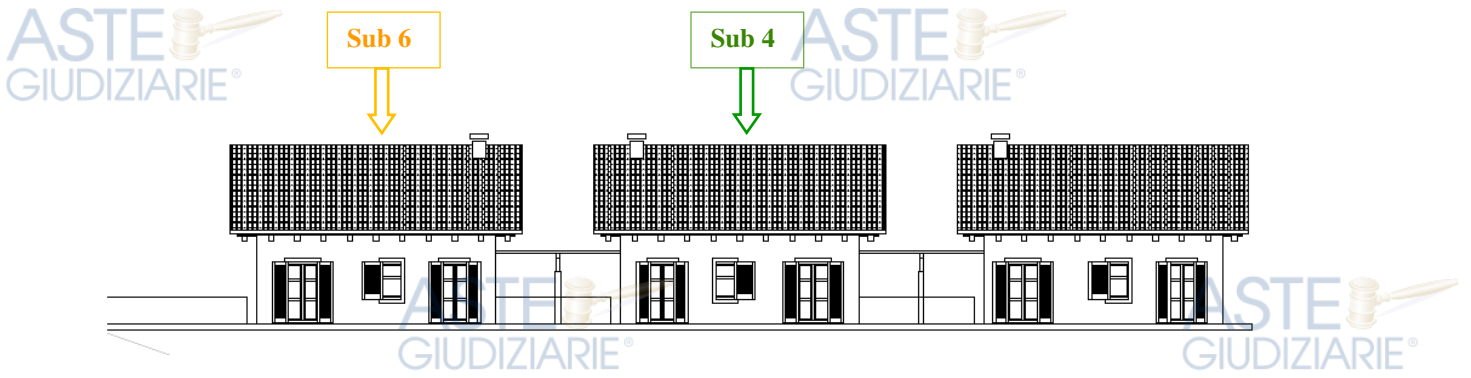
I due villini sub 4 e sub 6 visti da nord-est (estratto dalle tavole progettuali dell'arch. *)
